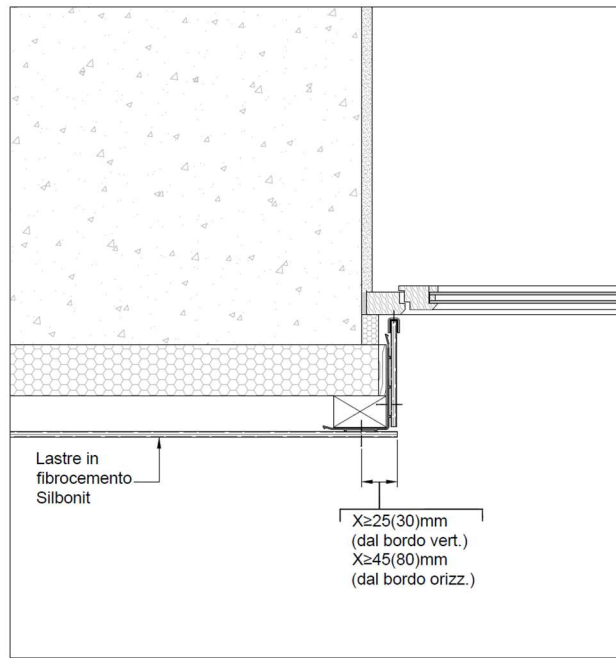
Esempio di sezione orizzontale tipo di facciata ventilata in corrispondenza di una finestra. Sottostruttura di legno
